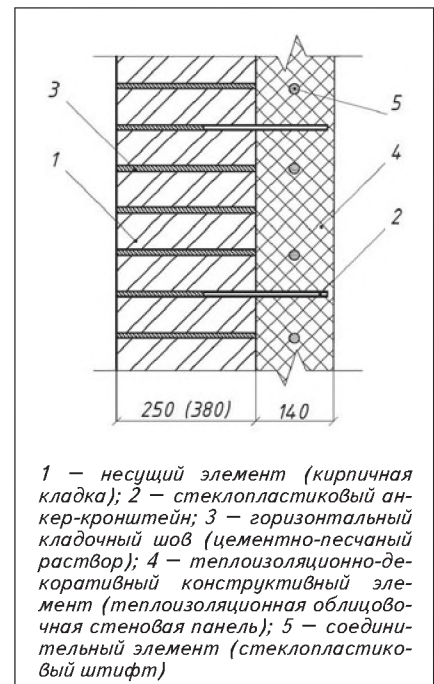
Поперечное сечение многослойной кирпичной кладки с плитным утеплителем
